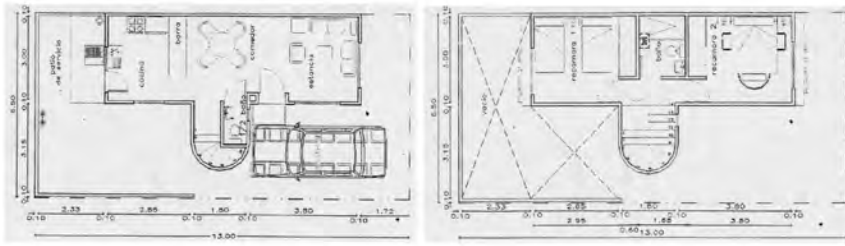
Planta Baja y Alta de Vivienda de Interés Social.
